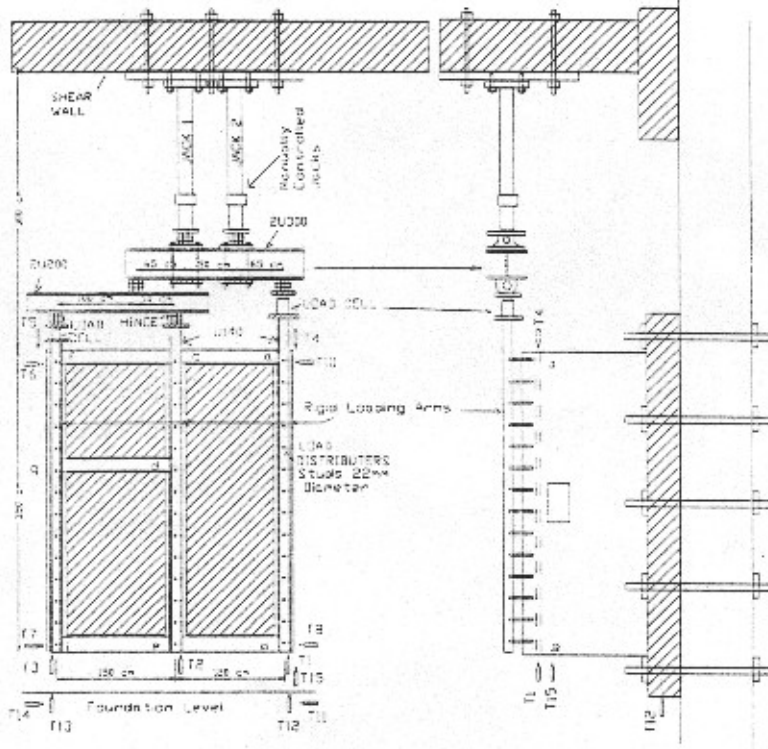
Özel Betonlu Panellerin Planı,Kesidi ve Ayrıntıları
